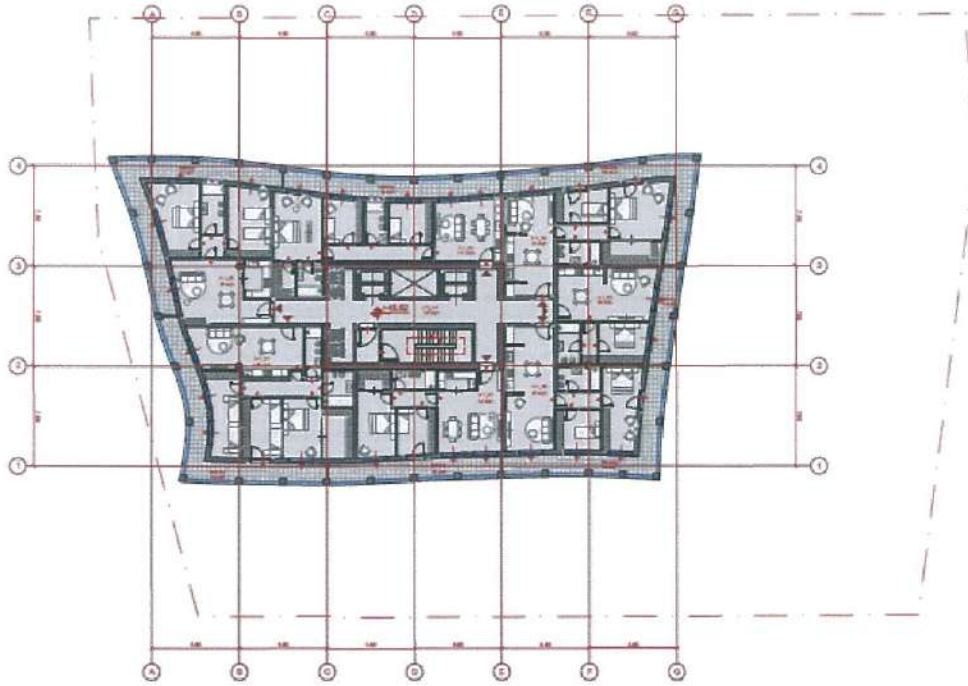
Planimetria e katit 12, në kuotën +48.62 SIP 994 m²
